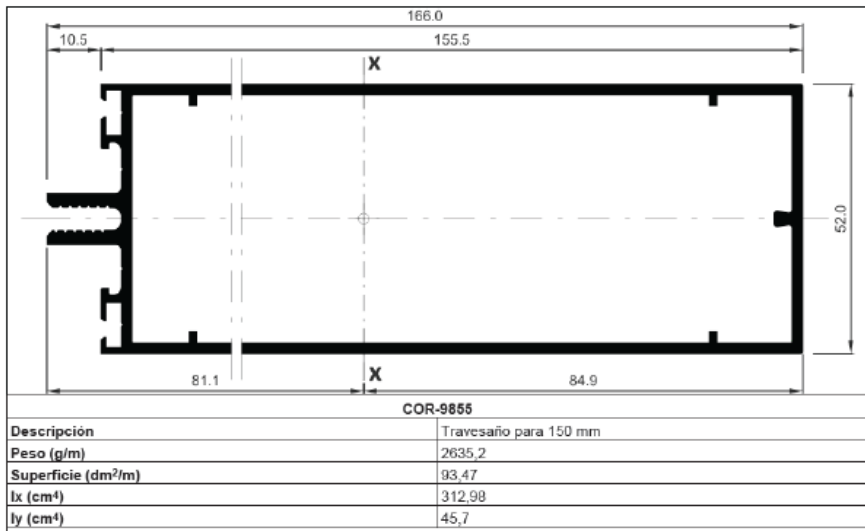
Perfil dispuesto como travesaño horizontal en fachada.
